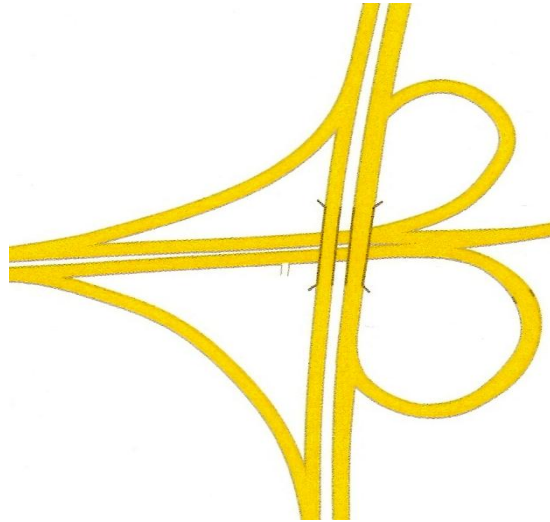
MÚK Ořech osmičková křižovatka [Zdroj autor DP]
